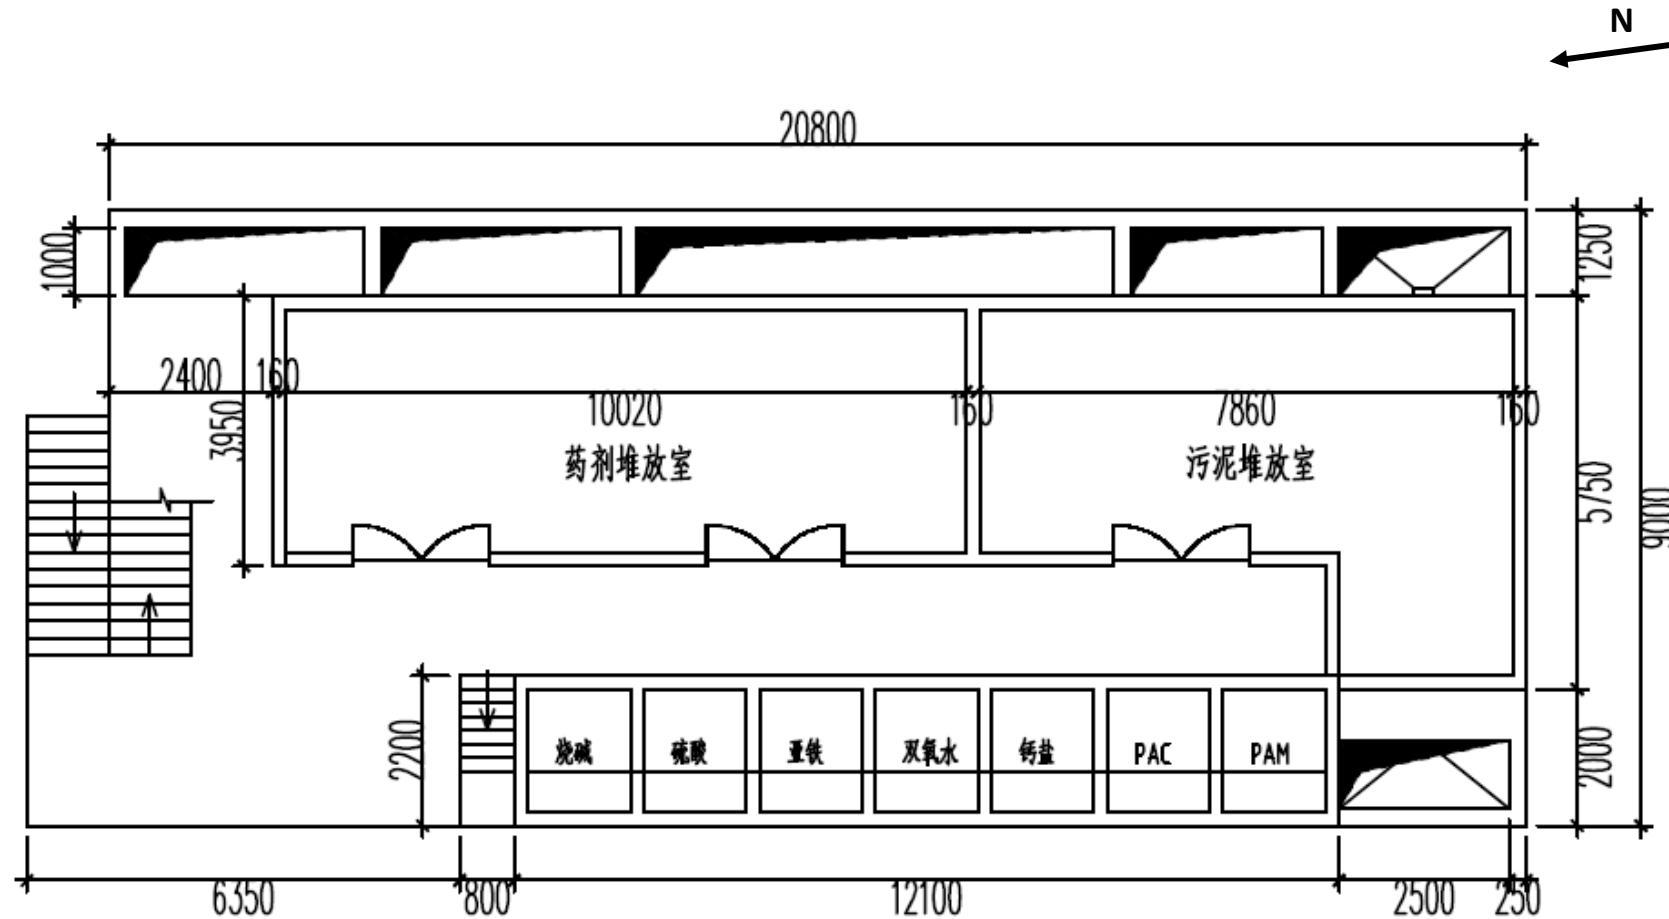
处理构筑物2二层平面布置图 (1~5.5m)
